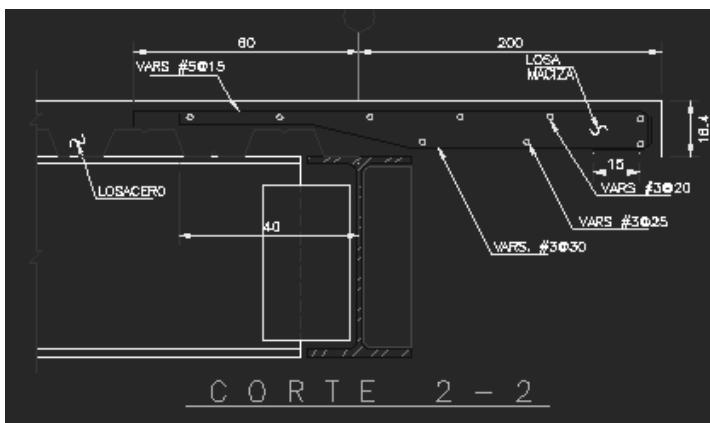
Armado del volado en dirección perpendicular a la losacero.
